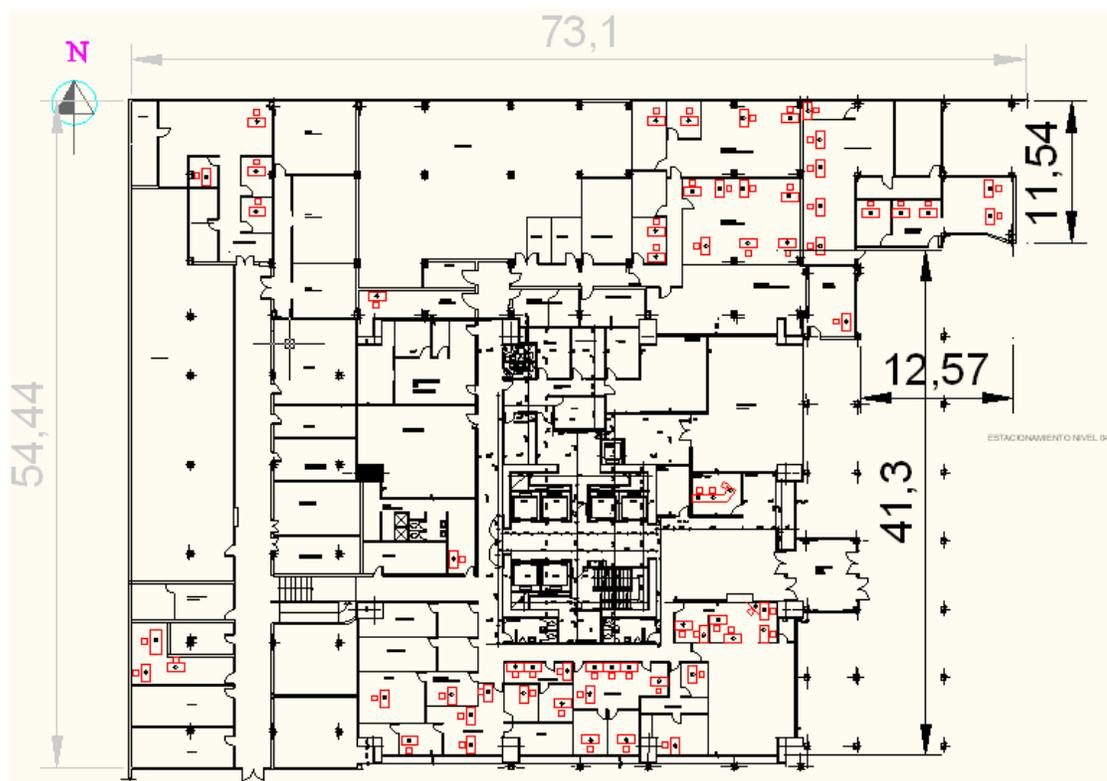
Dimensiones nivel inferior Planta Baja (unidades en metros)
